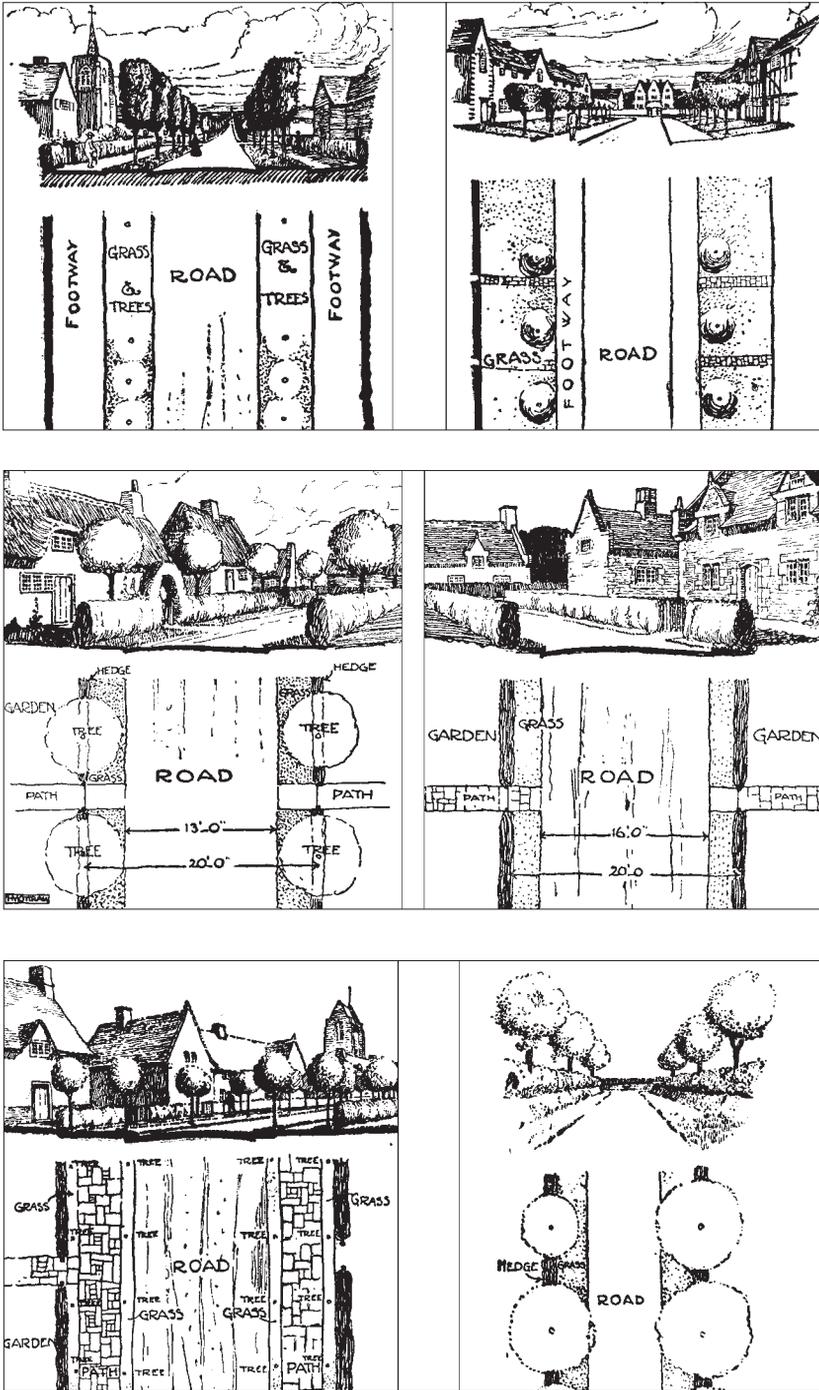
, 228 A, 228 B : Earswick, Letchworth et Hampstead.
